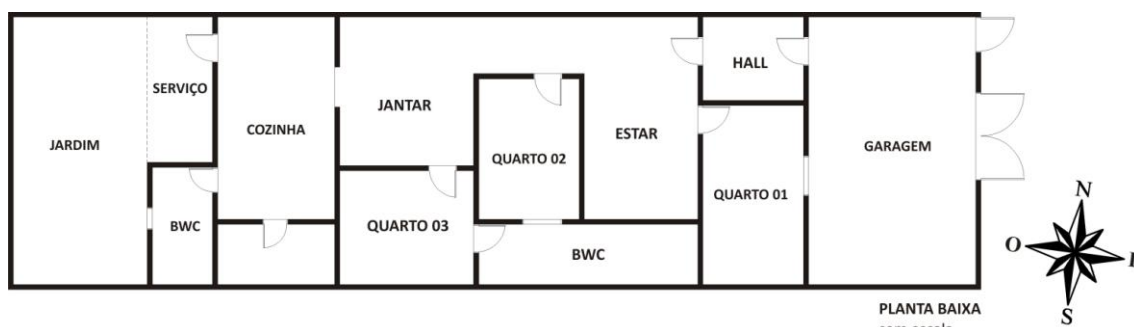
Planta esquemática da habitação geminada em sua tipologia original.
